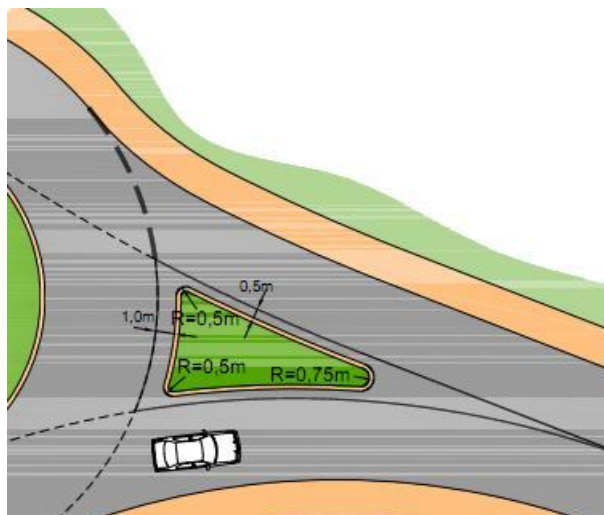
Pormenor do ilhéu separador [INSTITUTO DE INFRA-ESTRUTURAS RODOVIÁRIAS]
